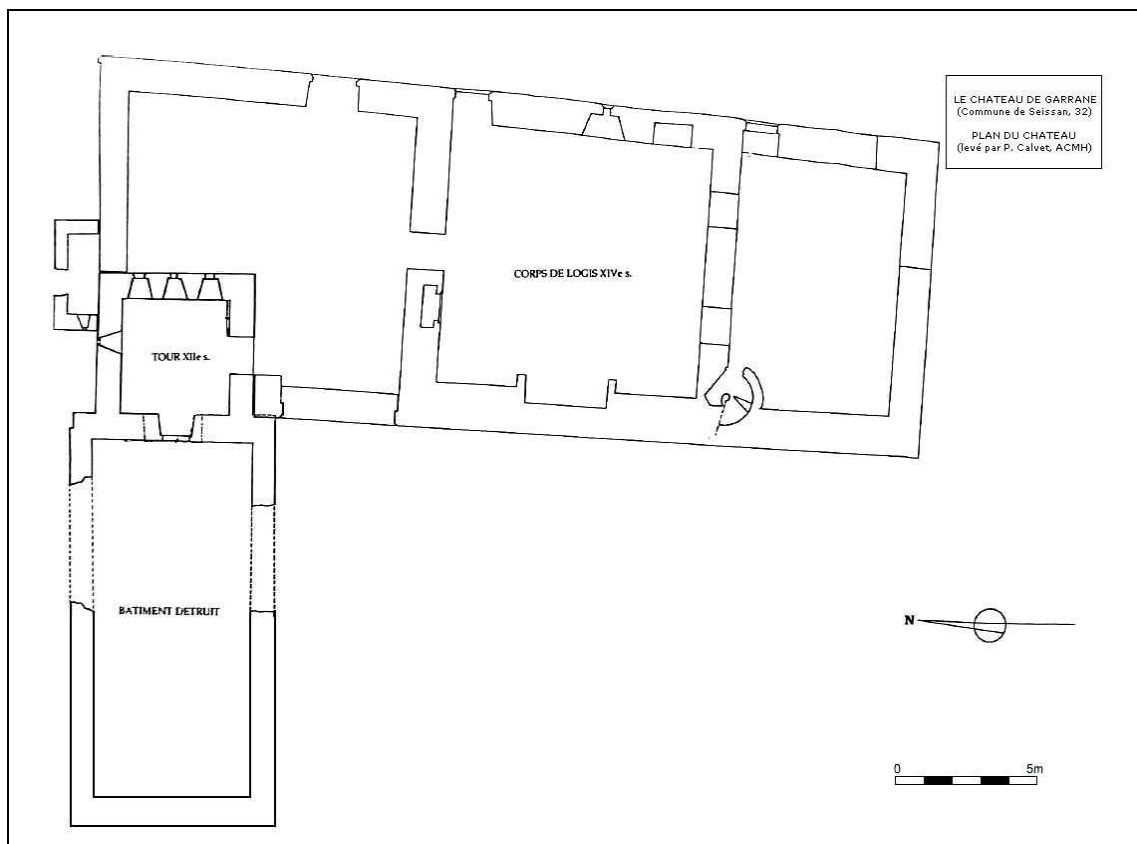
Plan au sol du rez-de-chaussée du château de Garrané (commune de Seissan) (relevés de P. Calvet).
